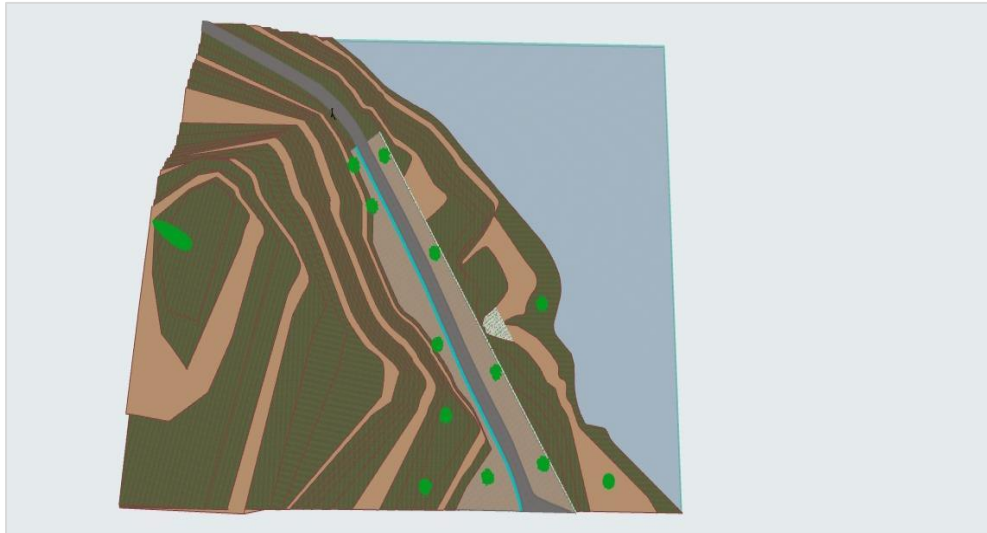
Modelado Bim del muro de gaviones con vista en planta
